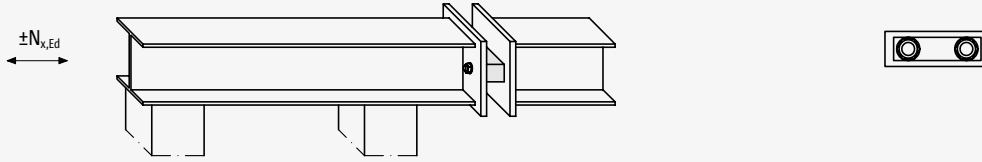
Schöck Isokorb® T typ S-N a T typ S-V
